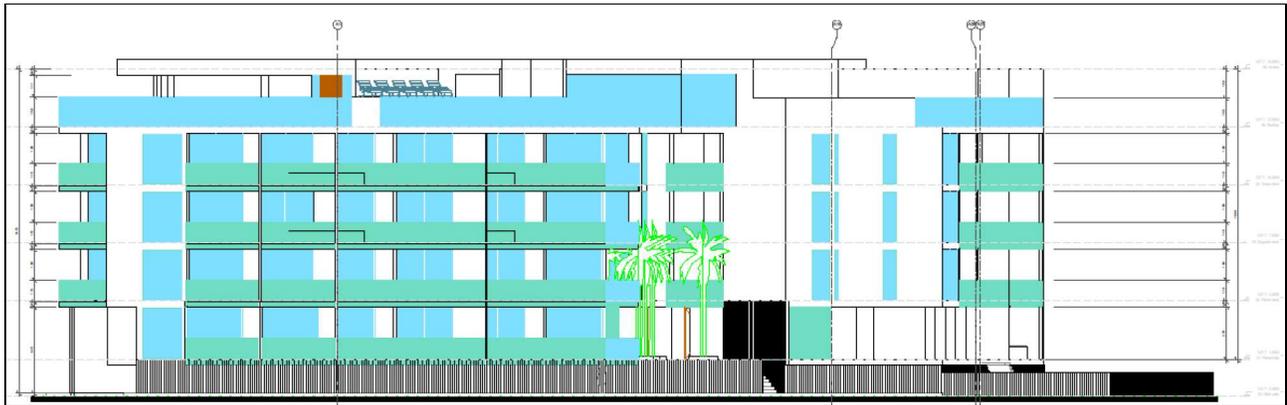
Se muestra la fachada del edificio sobre la Calle Pelicano.
